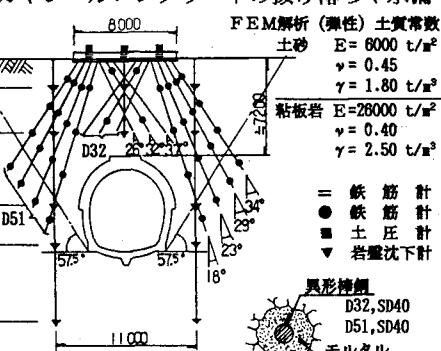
鉄筋モルタル杭・変換器配置図(断面) D32, φ118
